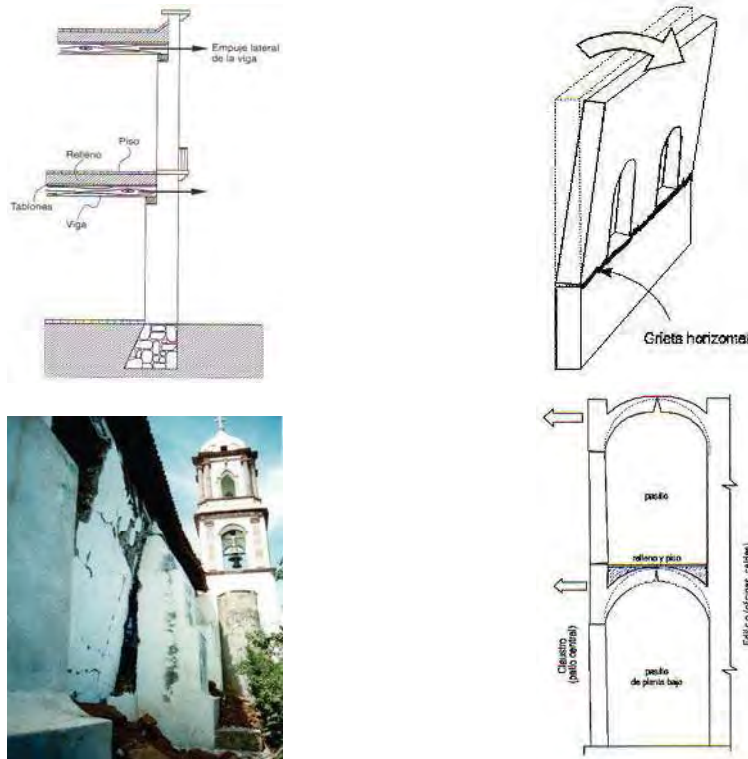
Tendencia de falla por volteo en muros por esbeltez y carga lateral
